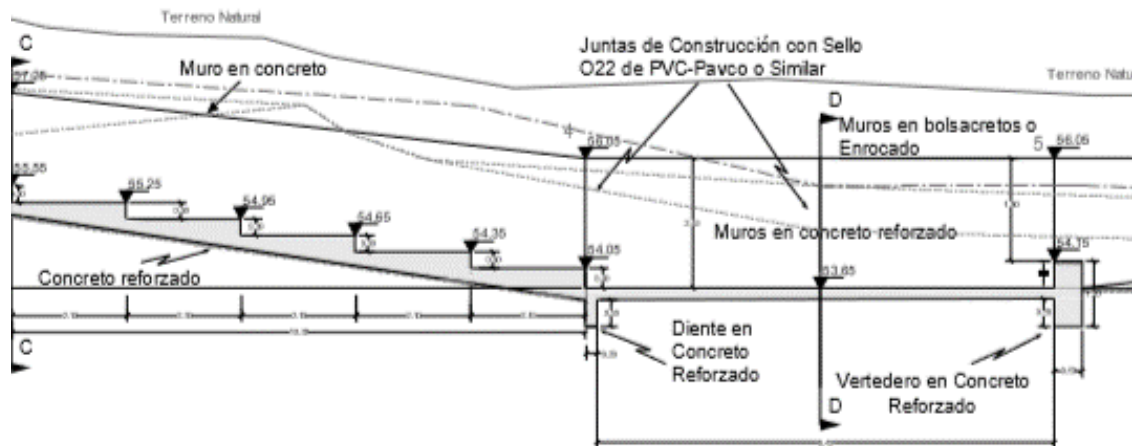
Perfil longitudinal de la estructura de disipación. Caño Piedras.
